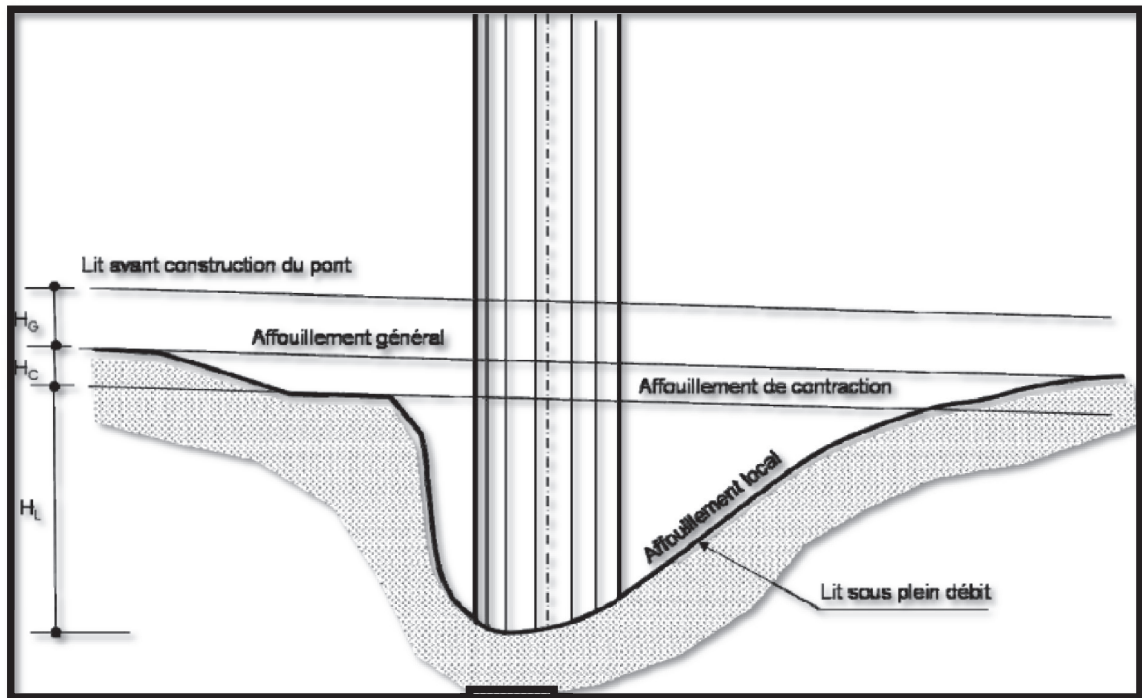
Les trois types d'affouillement au droit d'une pile d'un pont.
